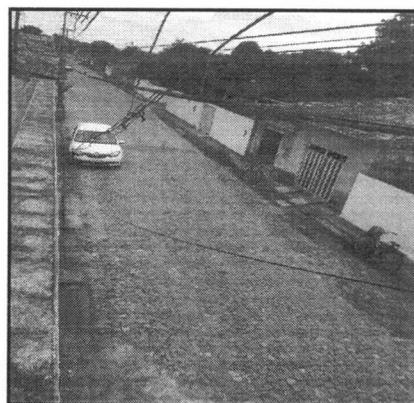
Imagem da rua de acesso ao imóvel com pavimentação em bloquete
